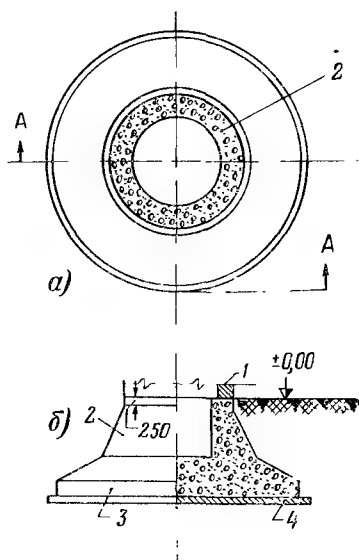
Фундамент под железобетонную дымовую трубу. а — план; б — разрез по А-А; 1 — ствол; 2 — стакан фундамента; 3 — плита фундамента; 4 — щебеночная подготовка
